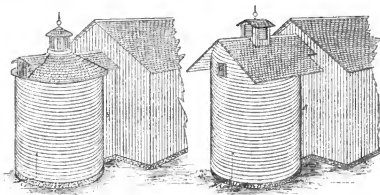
Der runde Silo in Verbindung mit Stallgebäuden.
